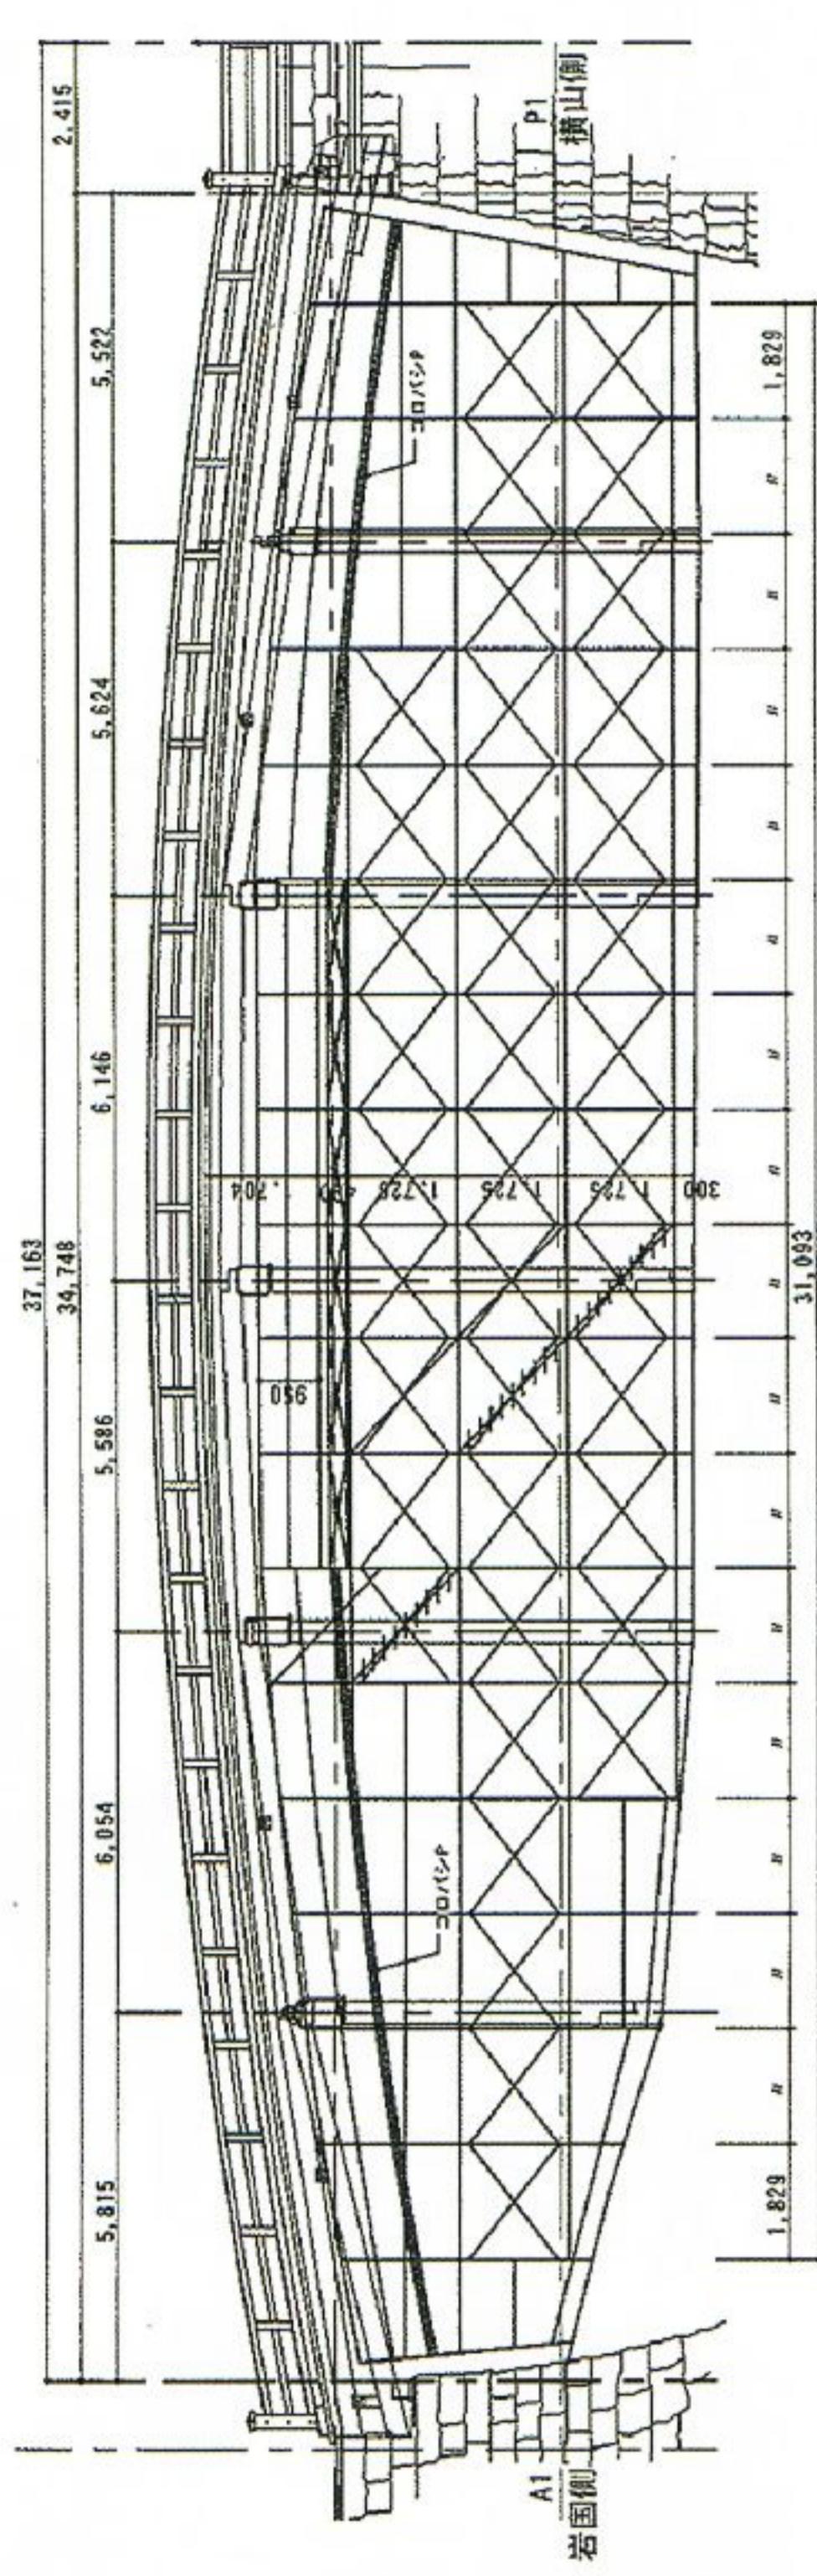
柱橋作業足場施工図(第1橋) 単位: mm
